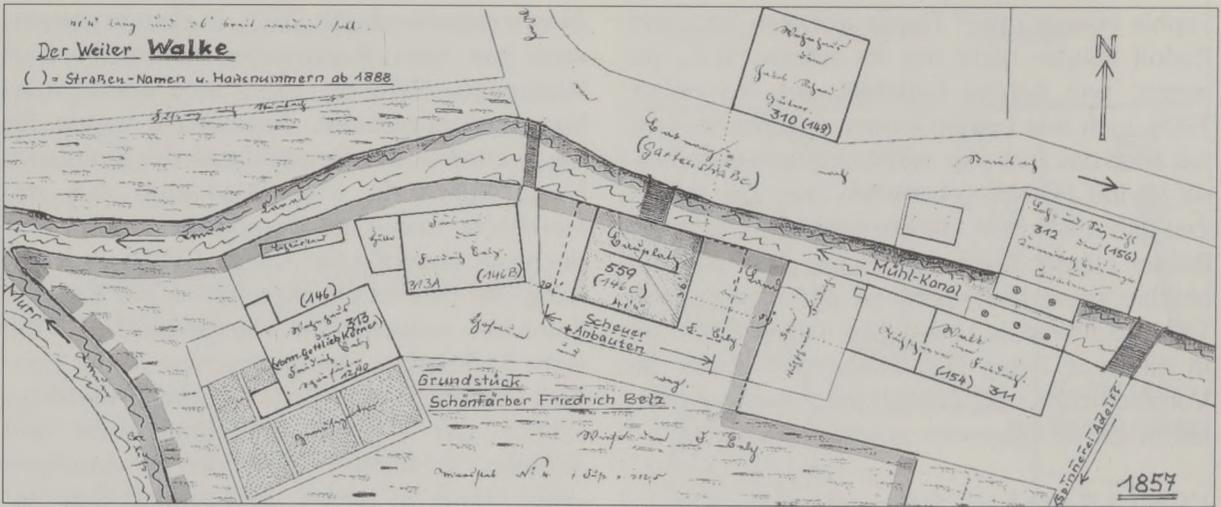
Lageplan-Ausschnitt vom Weiler Walke mit der Bebauung auf dem Grundstück Friedrich Belz im Jahr 1857, südlich des Kanals.
